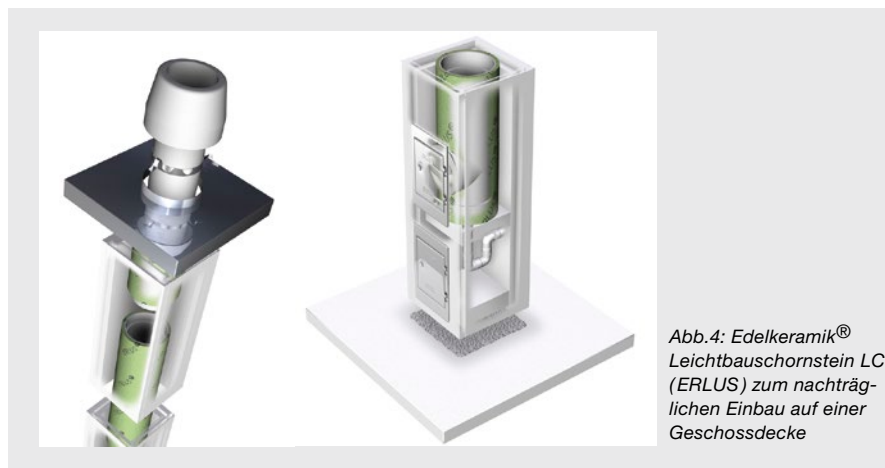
Edelkeramik[®] Leichtbauschornstein LC (ERLUS) zum nachträglichen Einbau auf einer Geschossdecke
